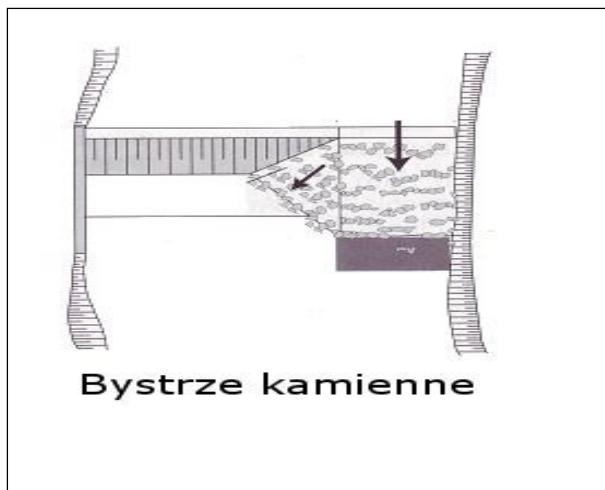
Rampa kamienna narzutowa na progu betonowym
